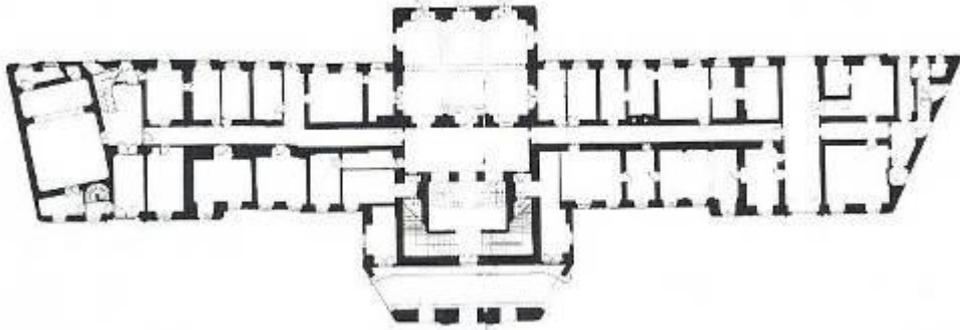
Palais Grassalkovich, Pozsony, Grundriss (EG)
